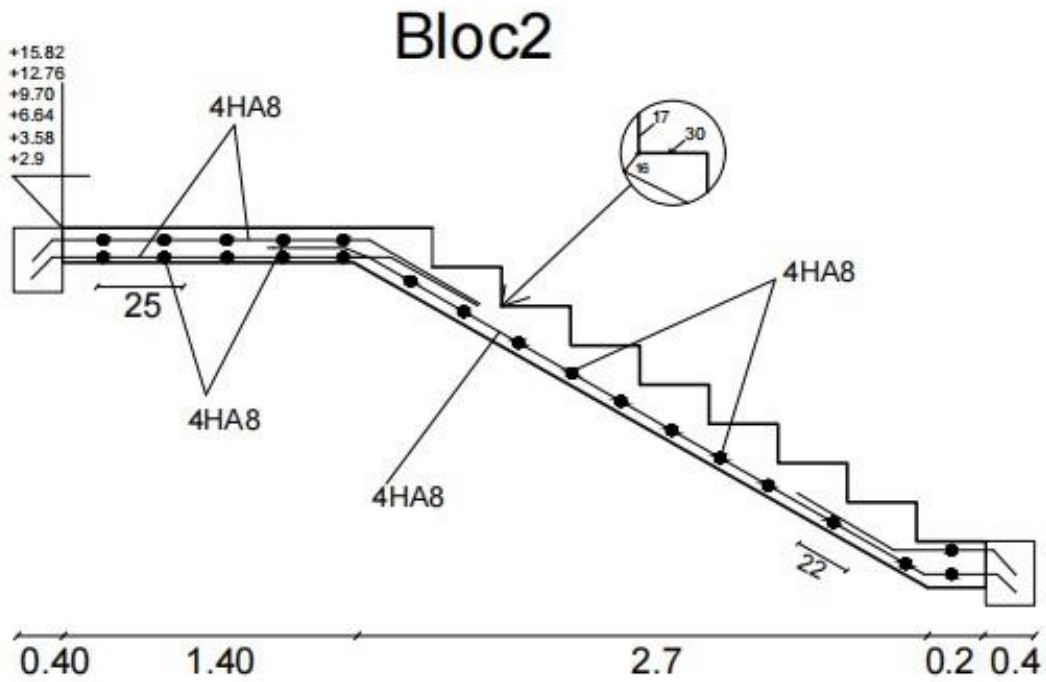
Schéma du ferrailage d'escalier bloc2.
